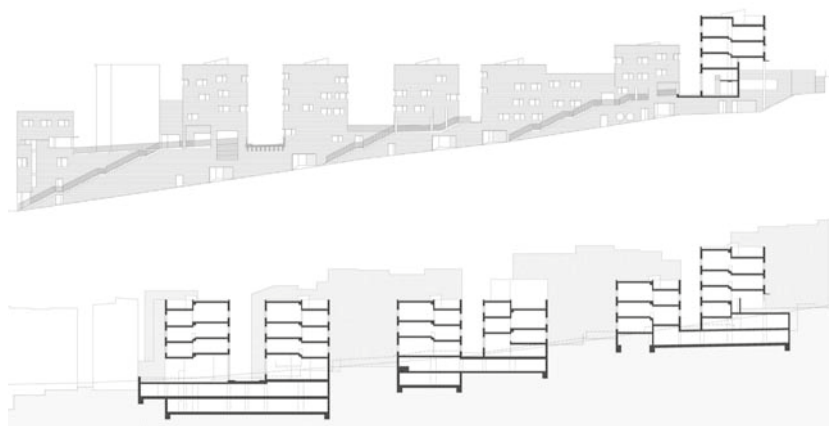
Barrio de la Sang: prospetto e sezione dei nuovi edifici.
